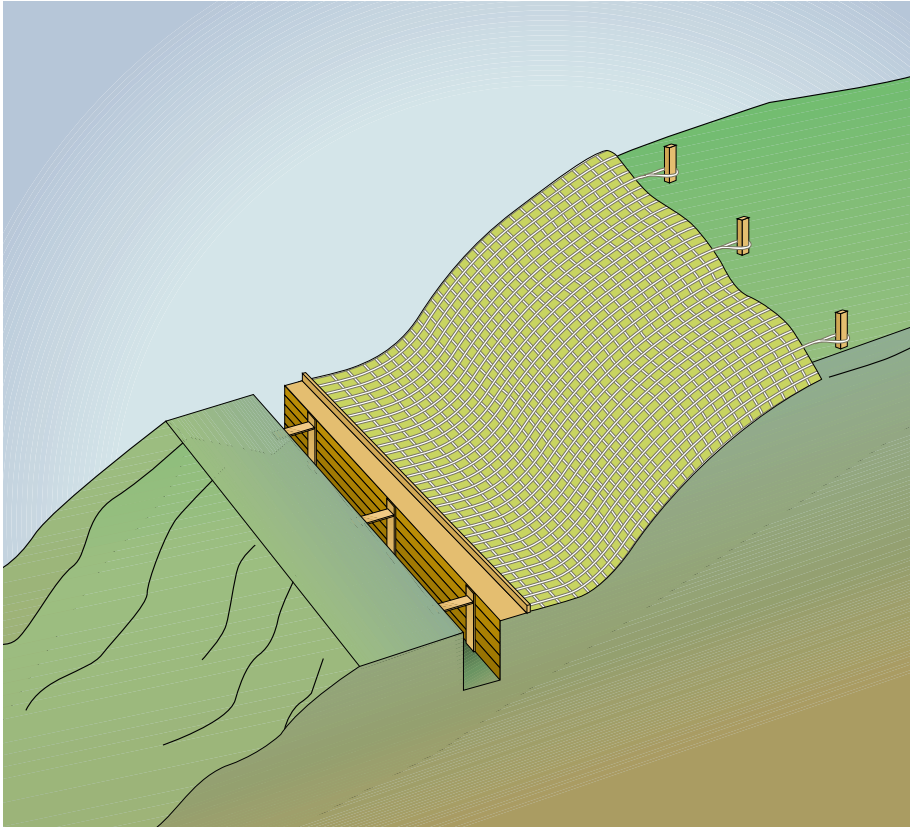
Escavação mista – com paredes em taludes e com paredes protegidas por cortinas
